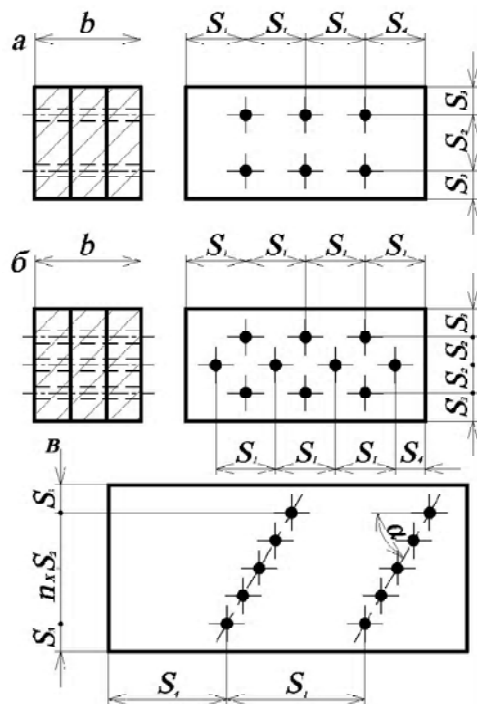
Схема расстановки гвоздей в пакетах: а – прямыми рядами; б – в шахматном порядке; в – косыми рядами.
